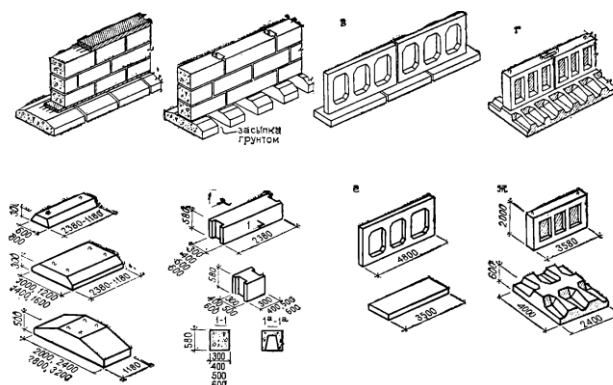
Сборные бетонные и железобетонные фундаменты: а – конструкция фундамента при слабых грунтах; б – укладка фундаментных блоков при плотных грунтах; в,г – фундаменты крупнопанельных зданий; д – элементы сборных бетонных фундаментов; е,ж – элементы панельных фундаментов
